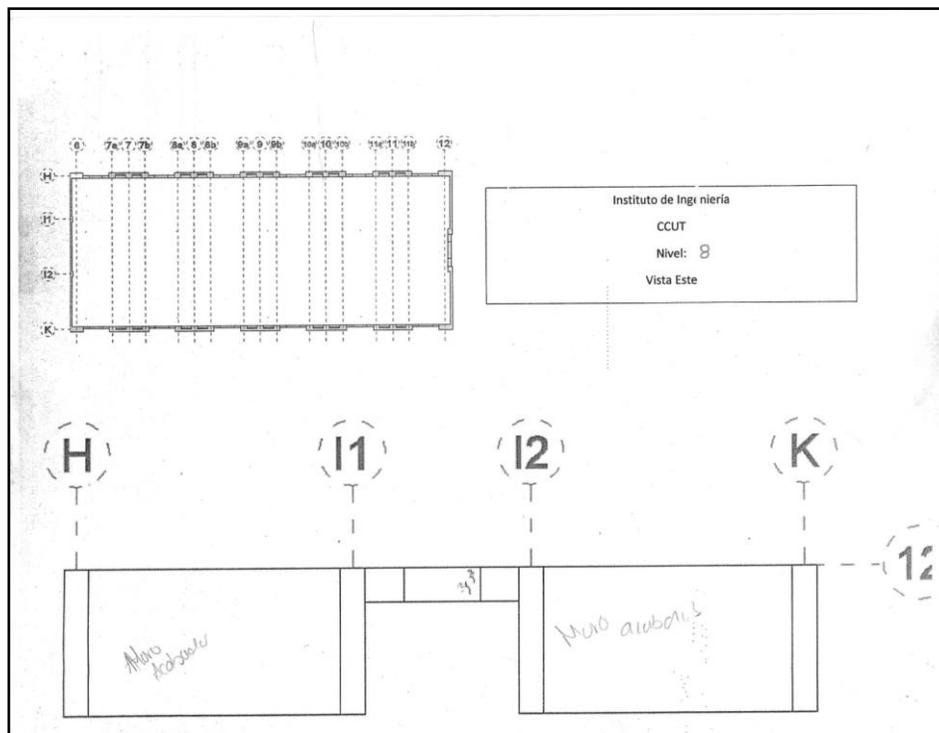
Elevación con levantamiento de grietas en columnas, muros y trabes, sobre eje 12 entre eje E y K. En este se indica que los muros están cubiertos por un acabado.
